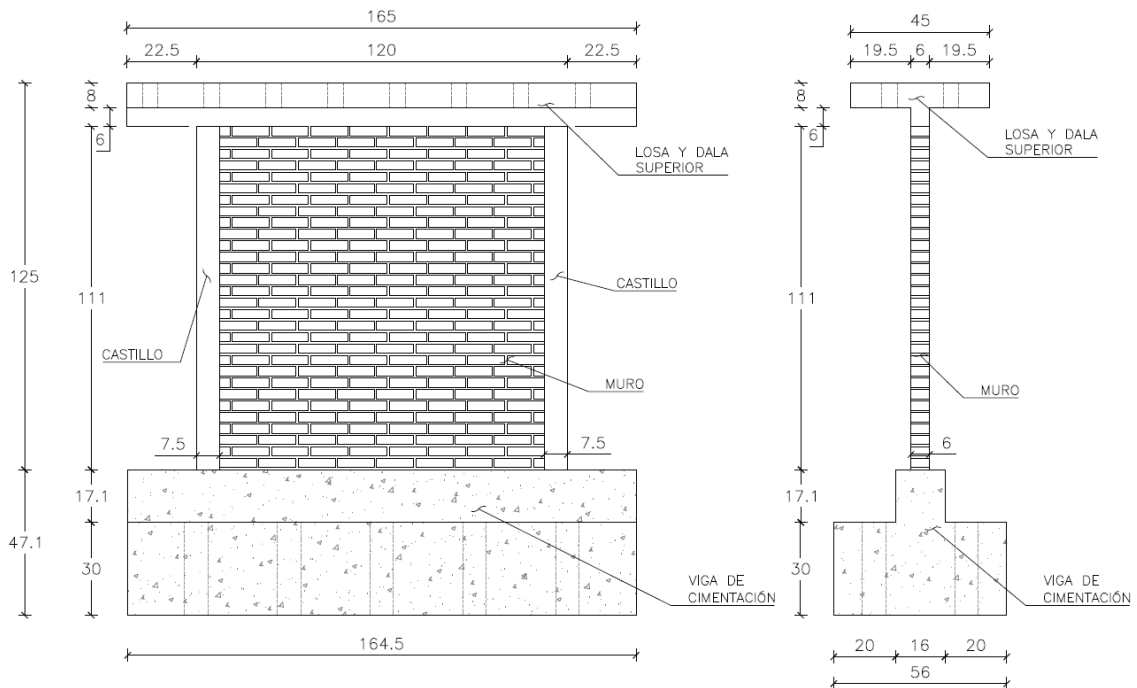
Modelo de muro con y sin refuerzo horizontal (MCR y MSR). Dinámico
